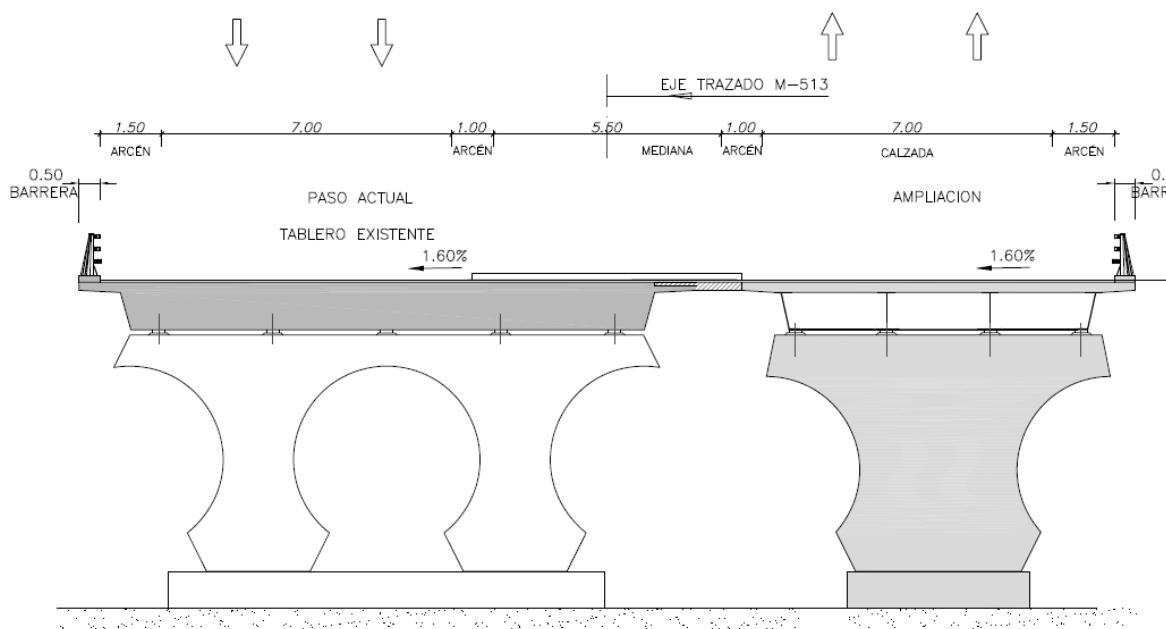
Sección transversal ESTRUCTURA 1 y estructura existente
